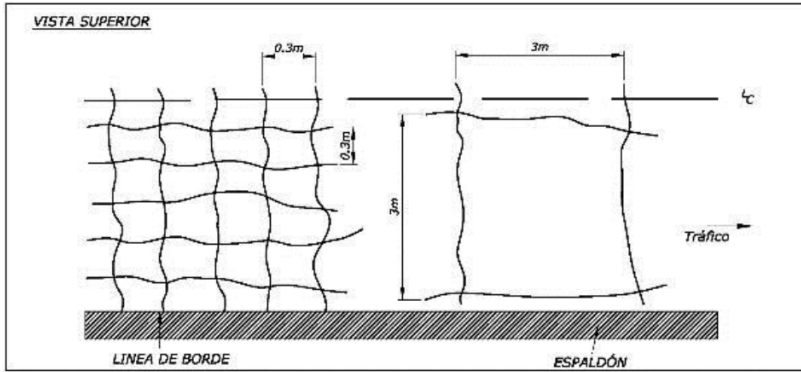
Esquema Grietas en Bloque – Pavimento Flexible
